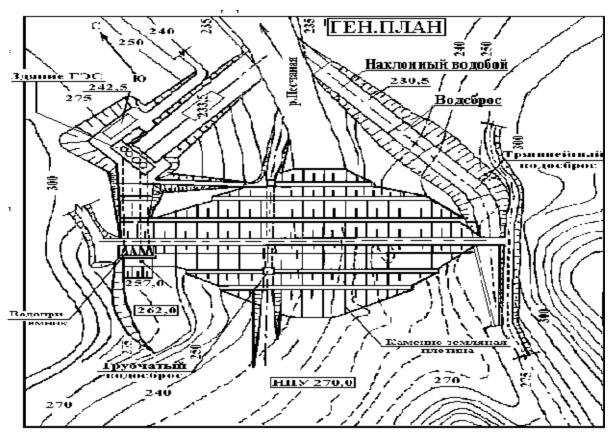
Генплан Красногородской ГЭС на реке Песчаная
